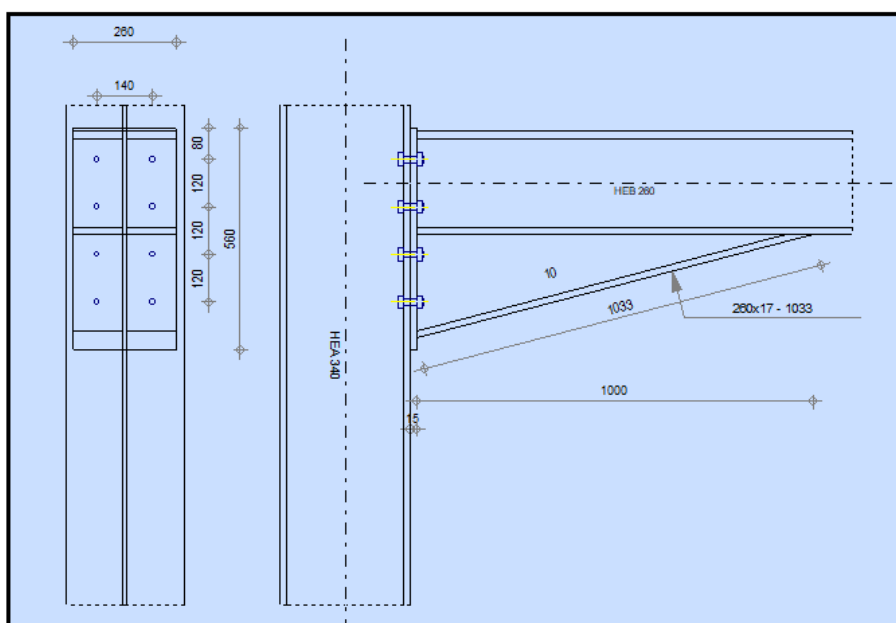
Vue en plan de l'assemblage poteau-console de la poutre de roulement.
